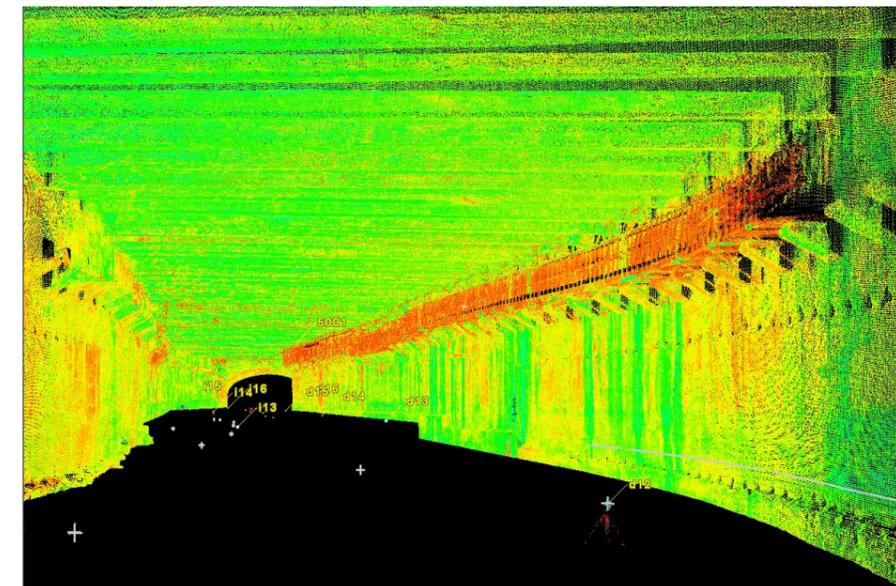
Cubrimiento del Huerva. Láser escáner. Estructura metálica anclada al muro (1)
